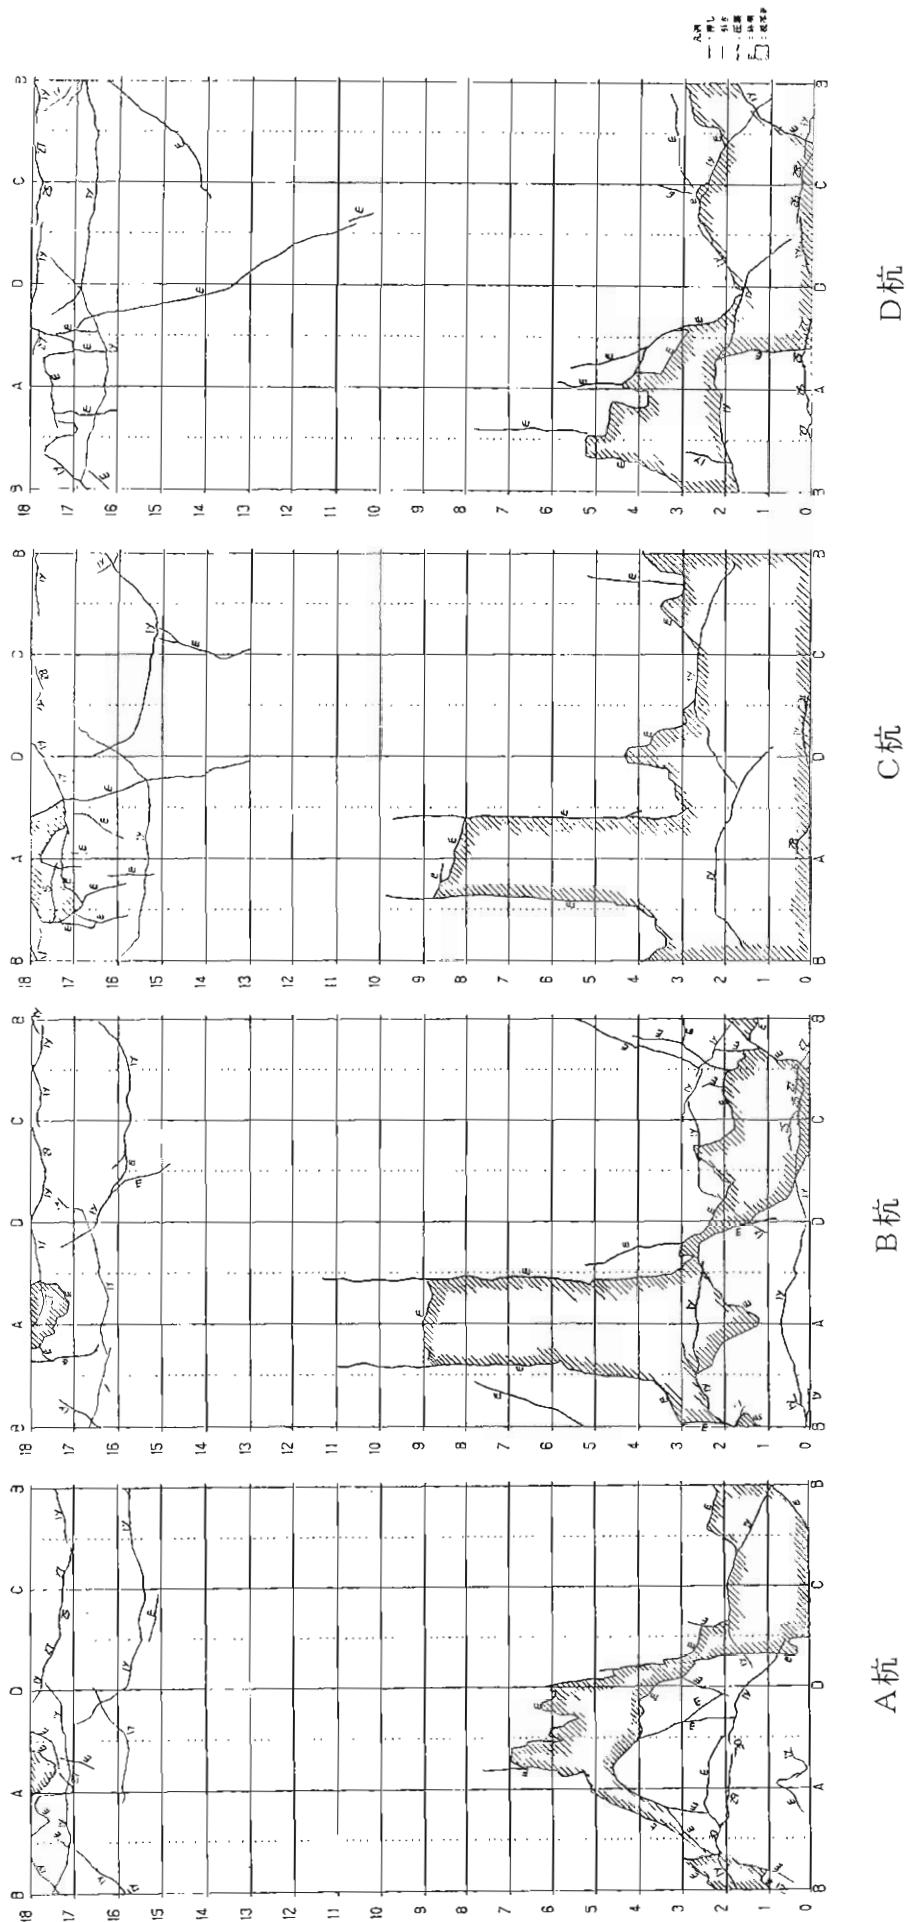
桁体のひび割れ状況展開図 (ケース11、1δy)
